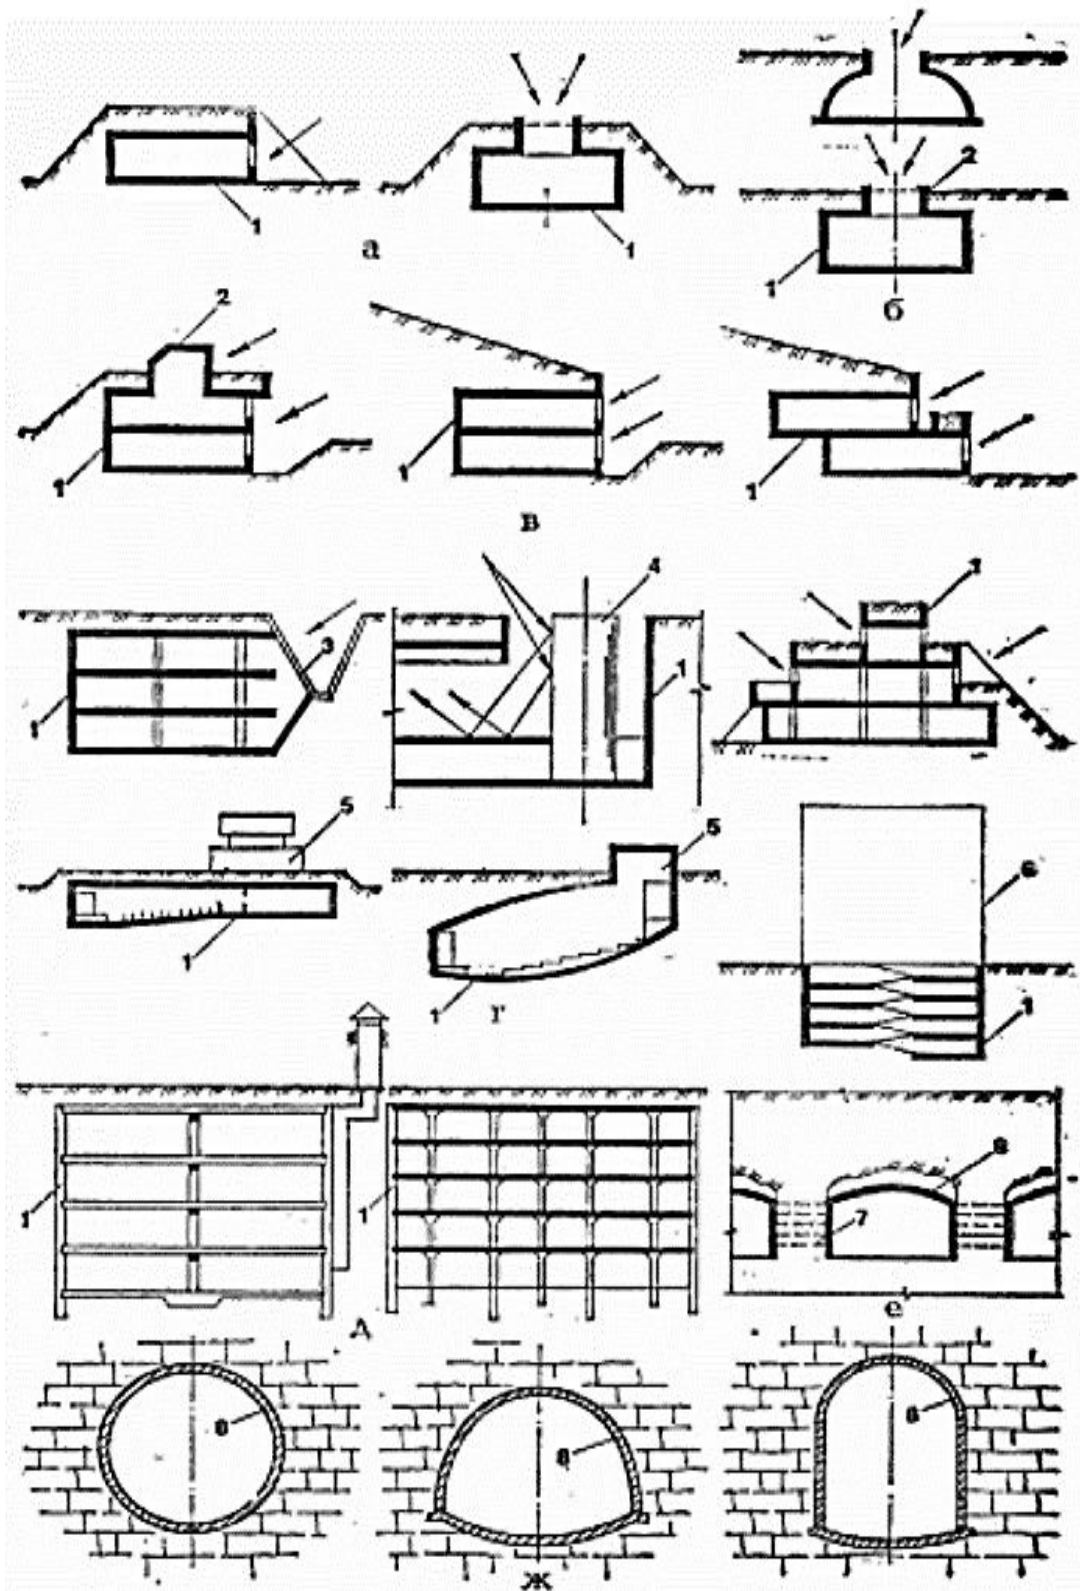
Схеми житлових, громадських та виробничих будівель:
